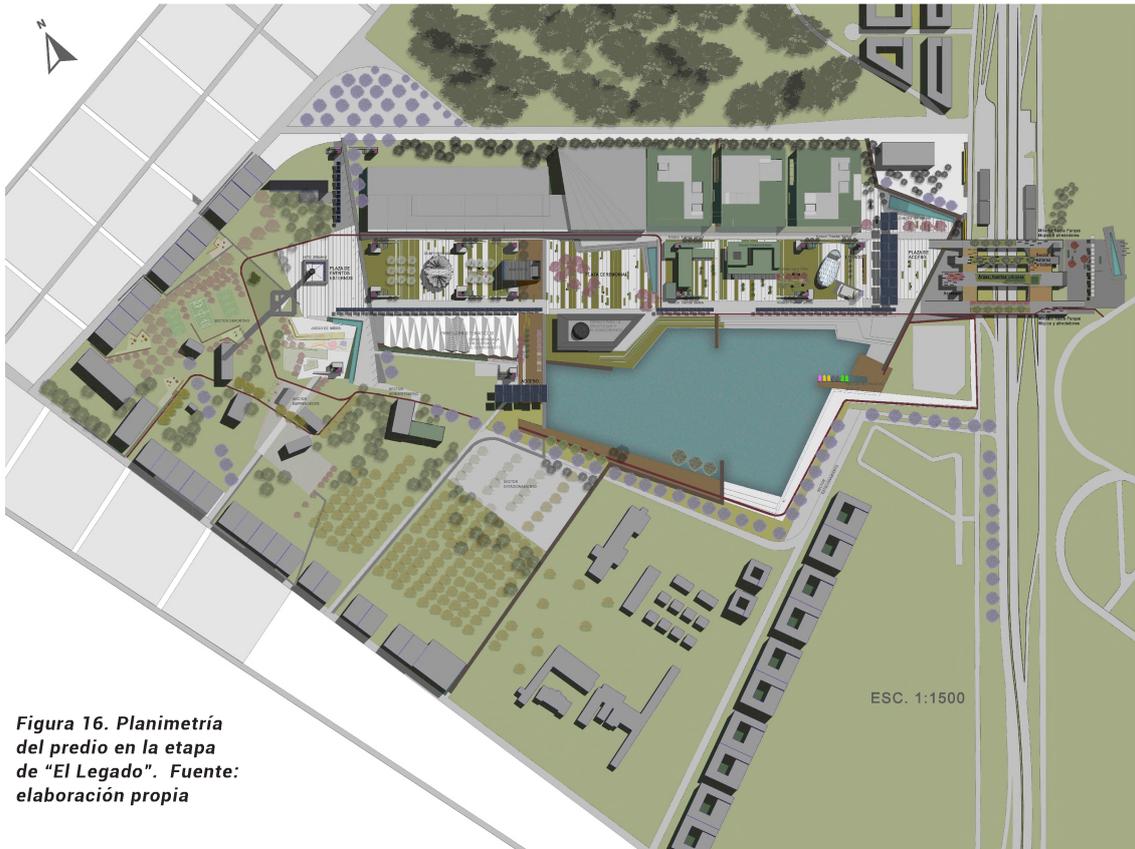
Planimetría del predio en la etapa de "El Legado". Fuente: elaboración propia
